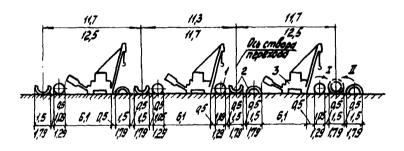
Схема раскладки плетей трубопровода диаметром 1020 и 1220 мм при монтаже на них утяжелителей типа УТК: I-П-последовательность монтажа утяжелителей на плеть трубопровода; I-плеть трубопровода; 2-полукольца утяжелителей; 3-трубоукладчик
